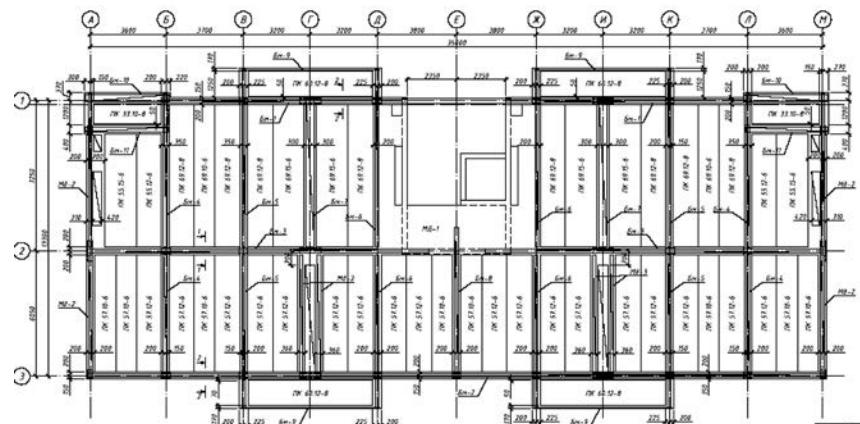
План будівлі на відмітці +15,520 зі схемою розкладки панелей ПК.
